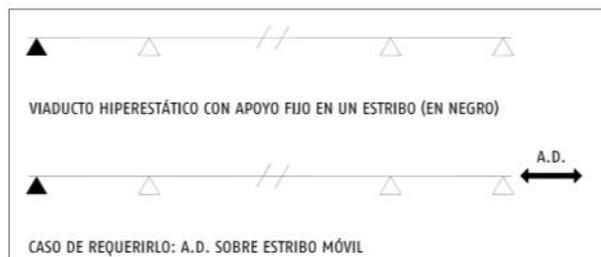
Disposición de aparatos de dilatación en estructuras hiperestáticas con estribo fijo
